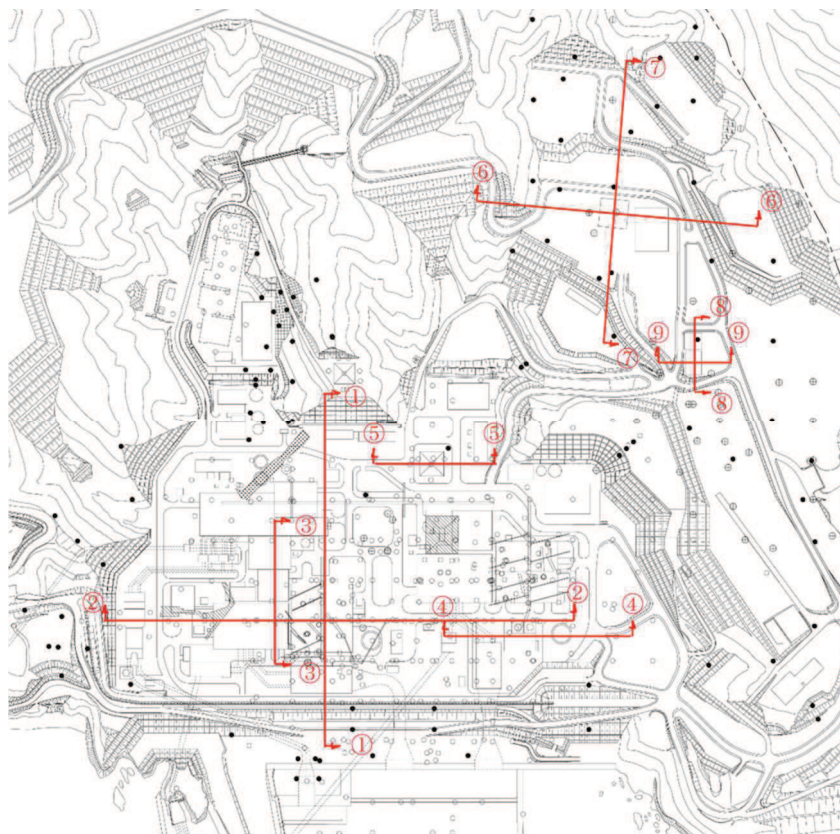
(1) 地質断面图位置 (①-①断面~⑨-⑨断面)
